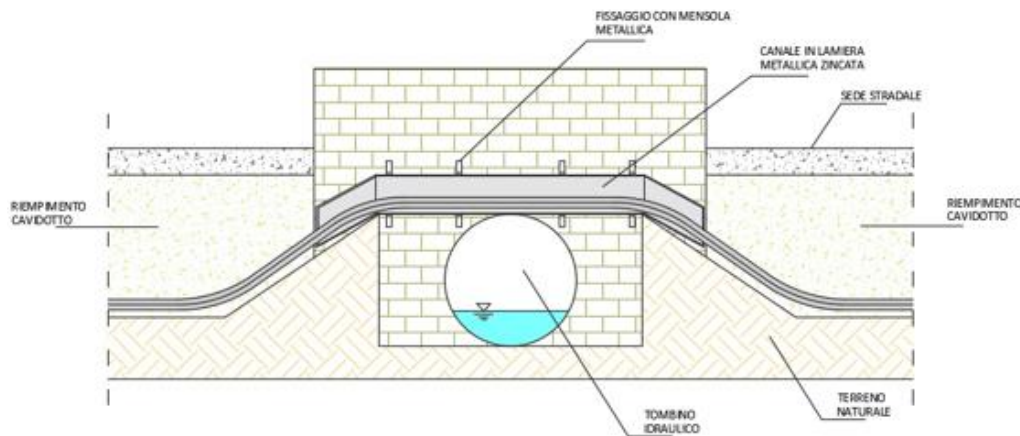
Sezione tipo di attraversamento mediante staffatura
